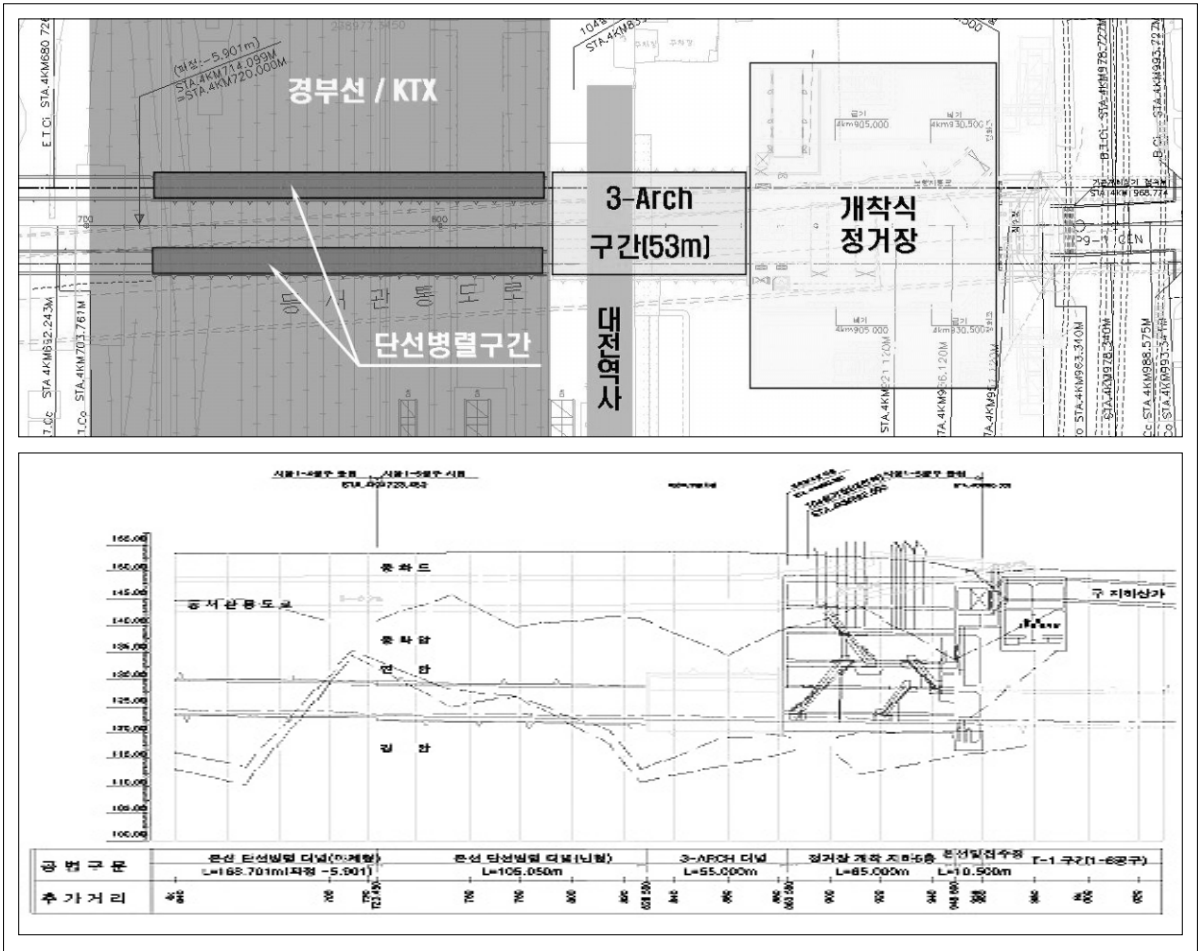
대전 지하철 1-5공구 현장 평면도 및 단면도
